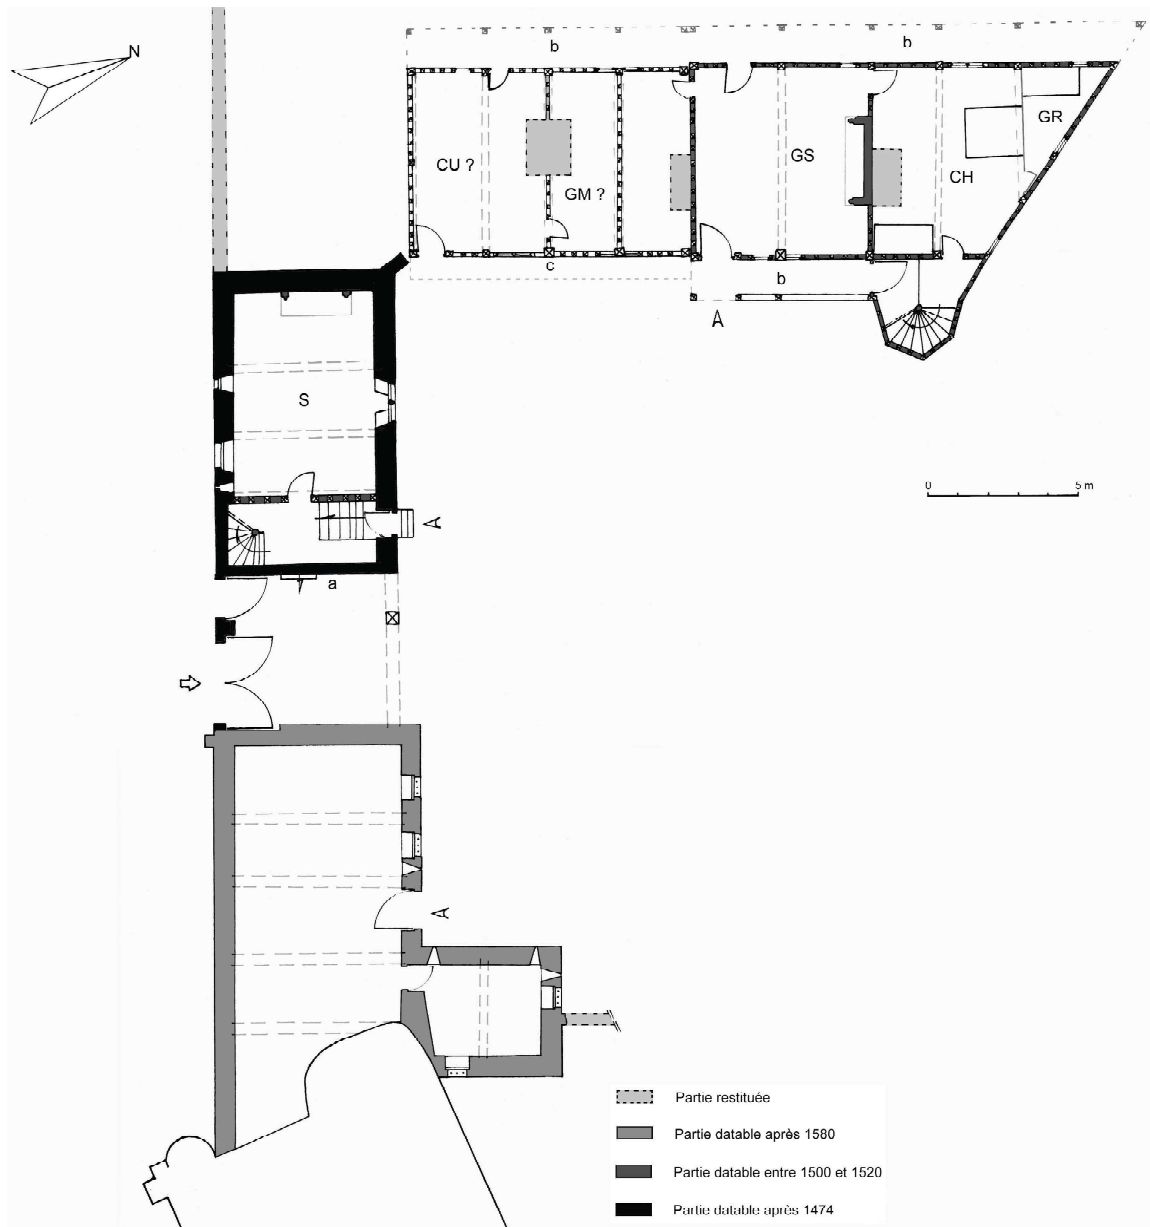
Le Mesnil-Jourdain. Plan restitué du rez-de-chaussée.
